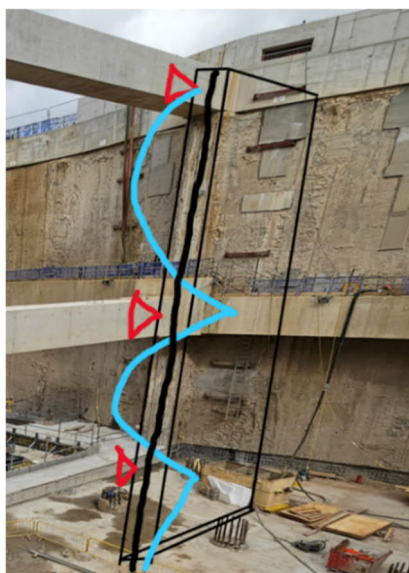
Imagen indicando sobre una fotografía del contrafuerte el trabajo como viga vertical trabajando a flexión apoyada en los puntales y la losa inferior.
